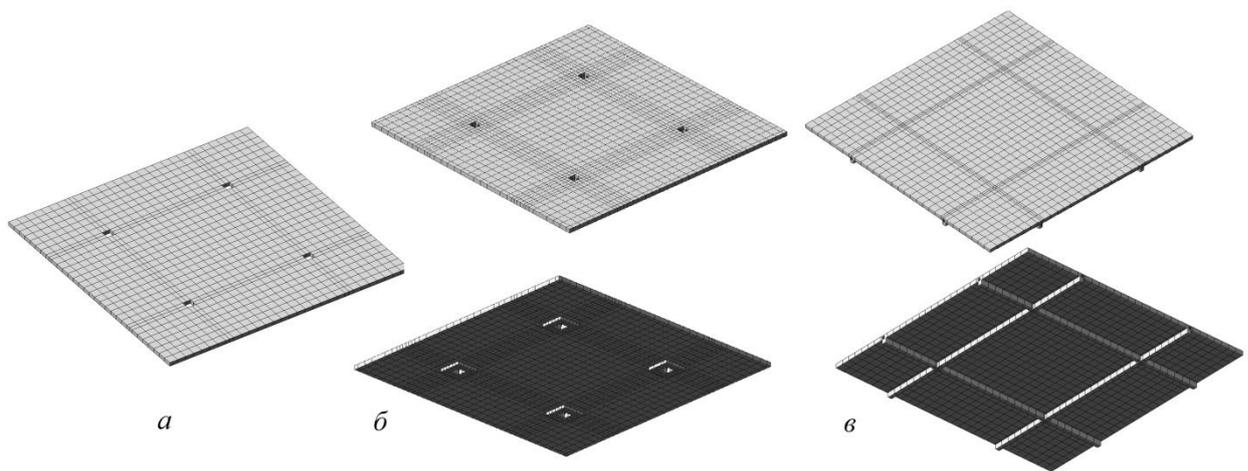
Расчетные модели фрагментов монолитного перекрытия: а – в виде плоской плиты перекрытия, б - плоской плиты с капителями, в – балочного с межколонными балками в двух направлениях
